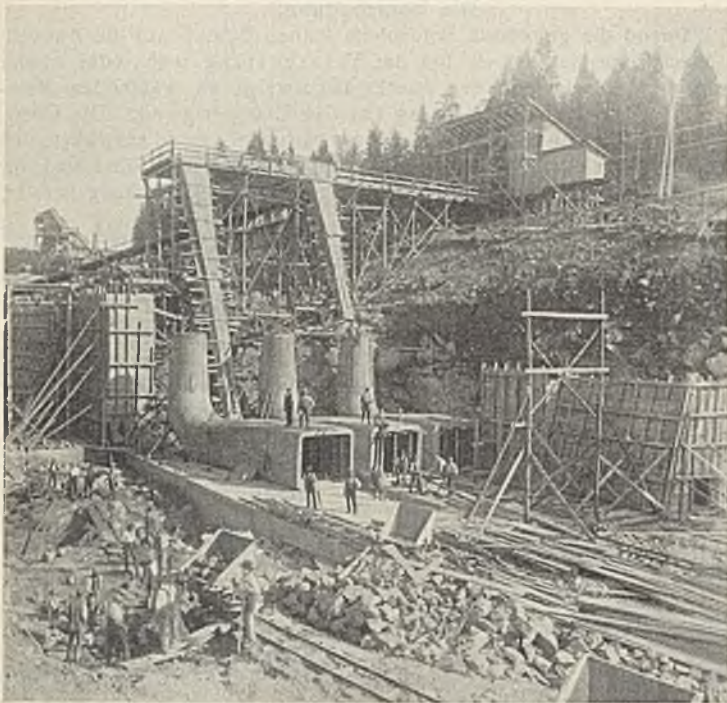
Regensperre. Betoneinbringung im Bauabschnitt I mit Brücke.
